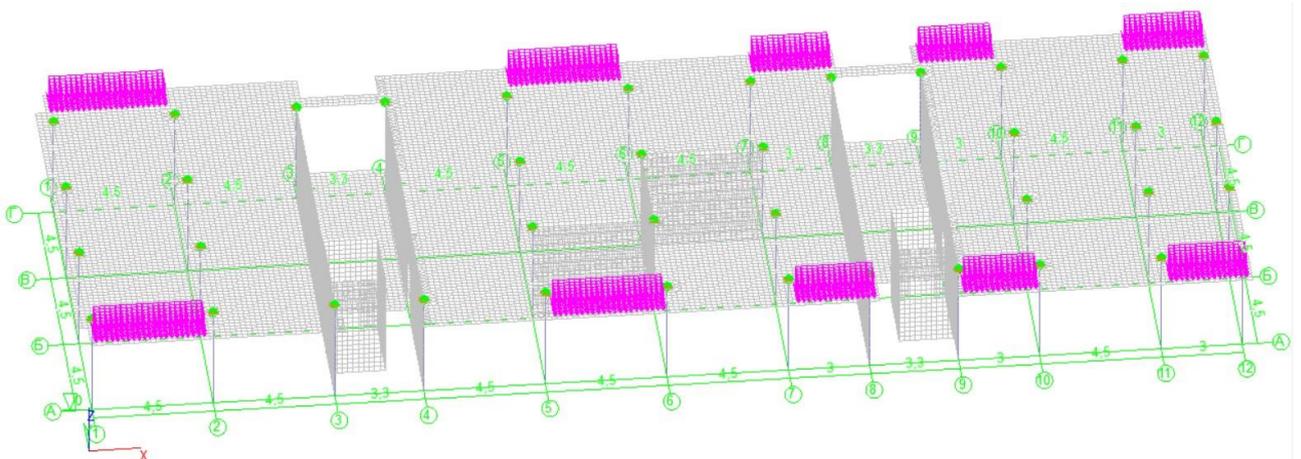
Общий вид временного загрузения перекрытия эксплуатационной нагрузкой на балконах
